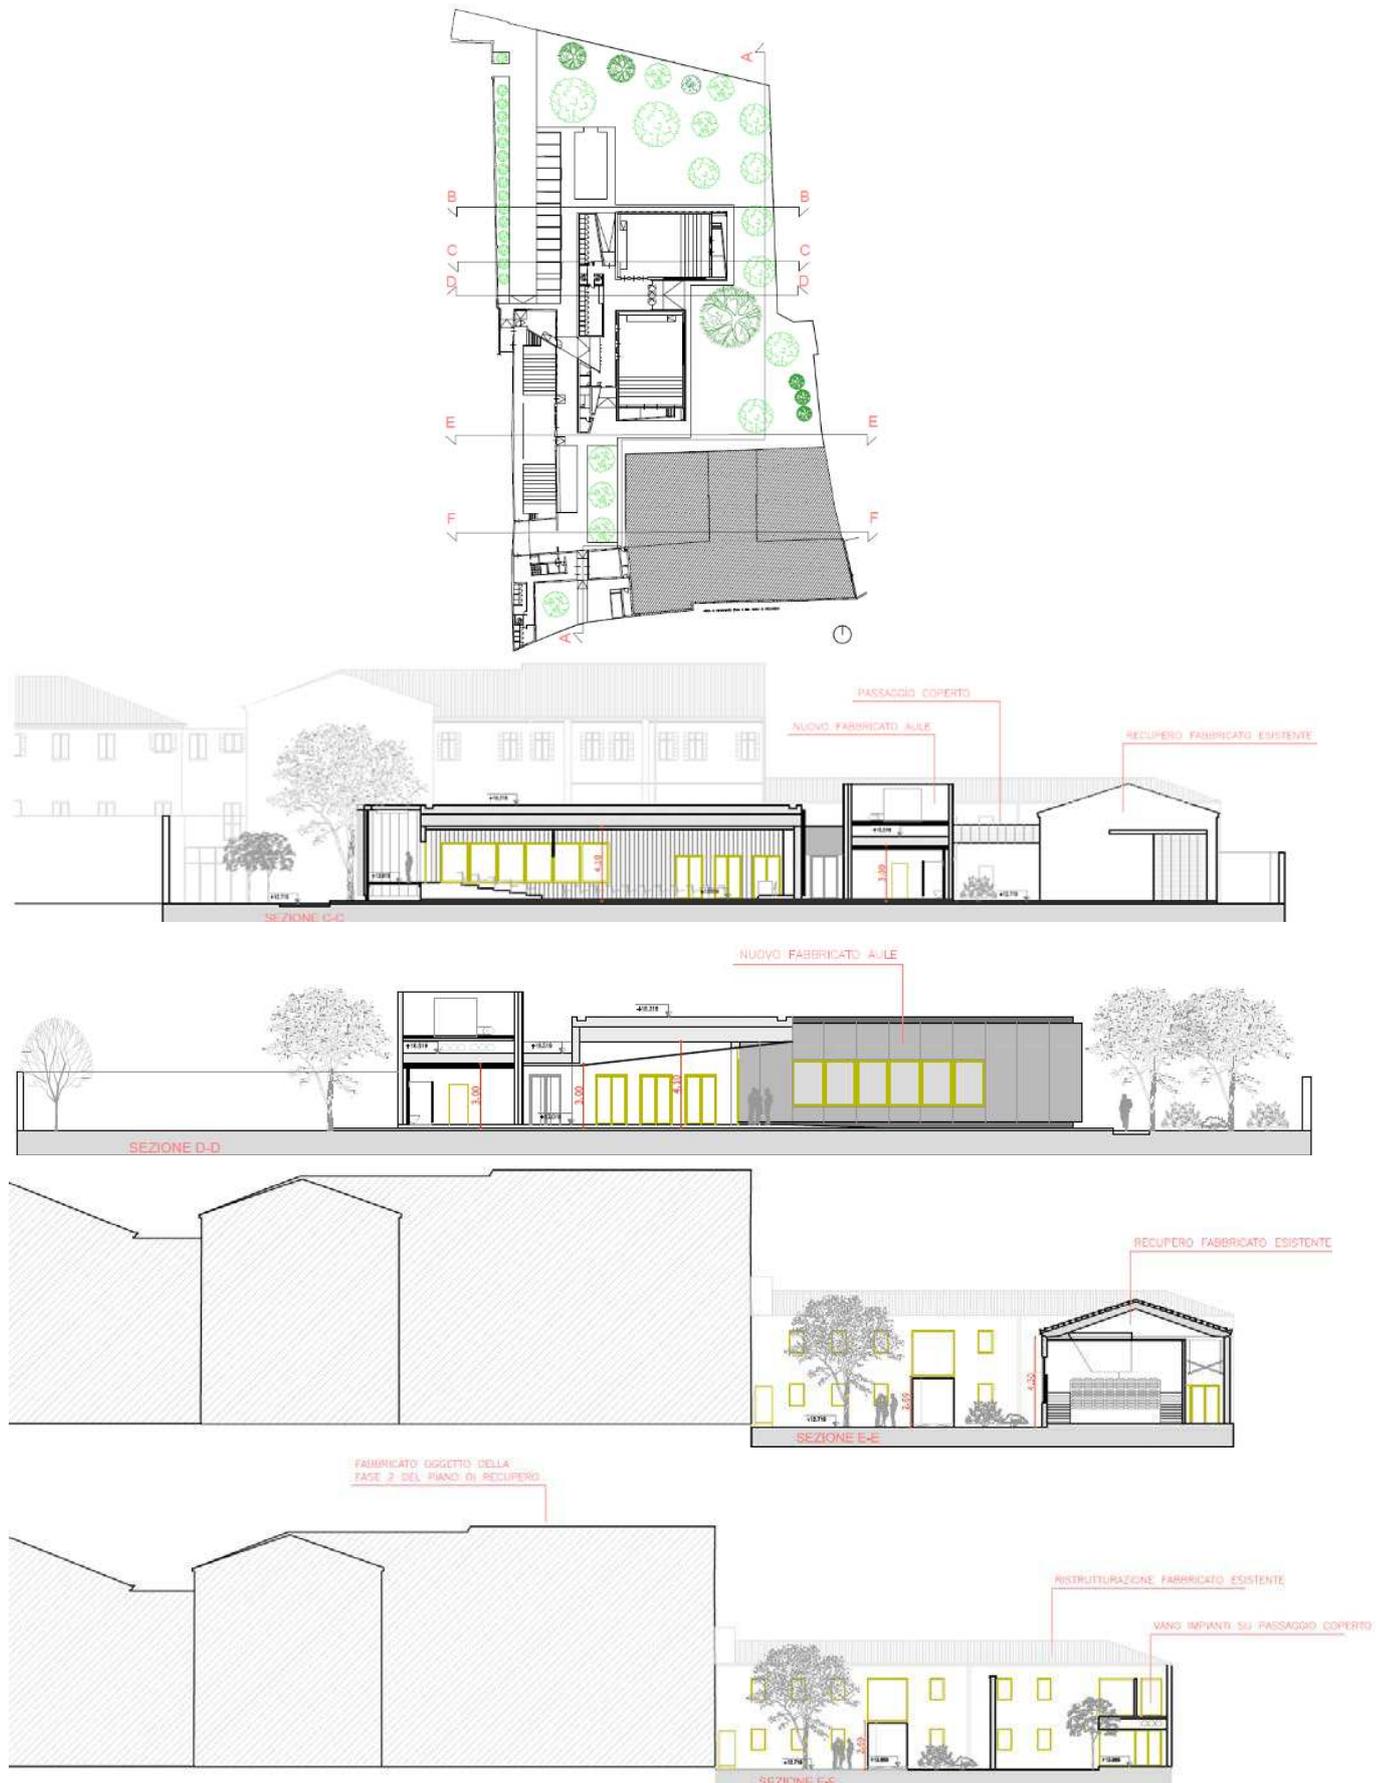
Estratto Tavola A07 del "Piano di recupero" - Prospetti e sezioni di progetto.
